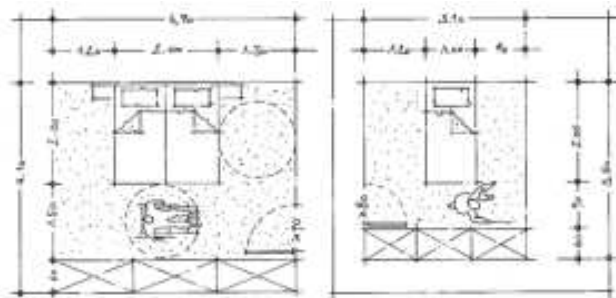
Bewegungsfläche und Platzbedarf im Schlafzimmer
